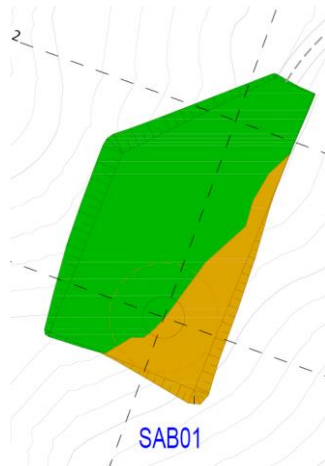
Planimetria piazzola SAB01 fase di esercizio
